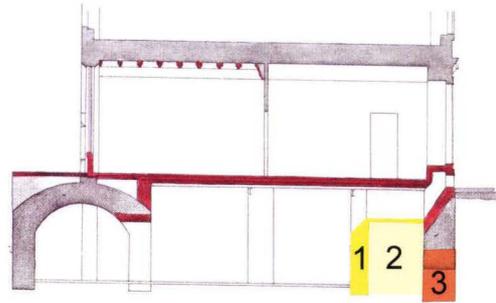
Freie Strasse 25. Hauptfassade. Baueingabeplan von 1883; Querschnitt und Grundriss. Dargestellter Querschnitt ergänzt 2007. 1883 wurde der Keller im nördlichen strassenseitigen Teil des Hauses ausgehoben und mit einer preussischen Kappendecke überspannt. Die vollständige Abtiefung des Kellers erfolgte jedoch nur bis zur Mauer 1 hinter dem spätmittelalterlichen Fundament, um sich die aufwändige Unterfangung der Fassade zu ersparen. Für die Belichtung reichten zwei hoch liegende Oberlichter (unter den Fensterbänken des Erdgeschosses) und der niedrige Freiraum unter der Decke. 1883 befand sich der Hauseingang noch in der rechten Achse der Strassenfassade, was auch in der linken Fensterachse ein Oberlicht unterhalb der betreffenden Fensterbank ermöglichte. – 1970 erfolgte die vollständige Aushebung des Kellers (2) mit Abbruch der Mauer (1) und Unterfangung des Fassadenfundaments (3). – Plan: Baueingabeplan vom 21. Mai 1883, StABS, Bauplanarchiv.
